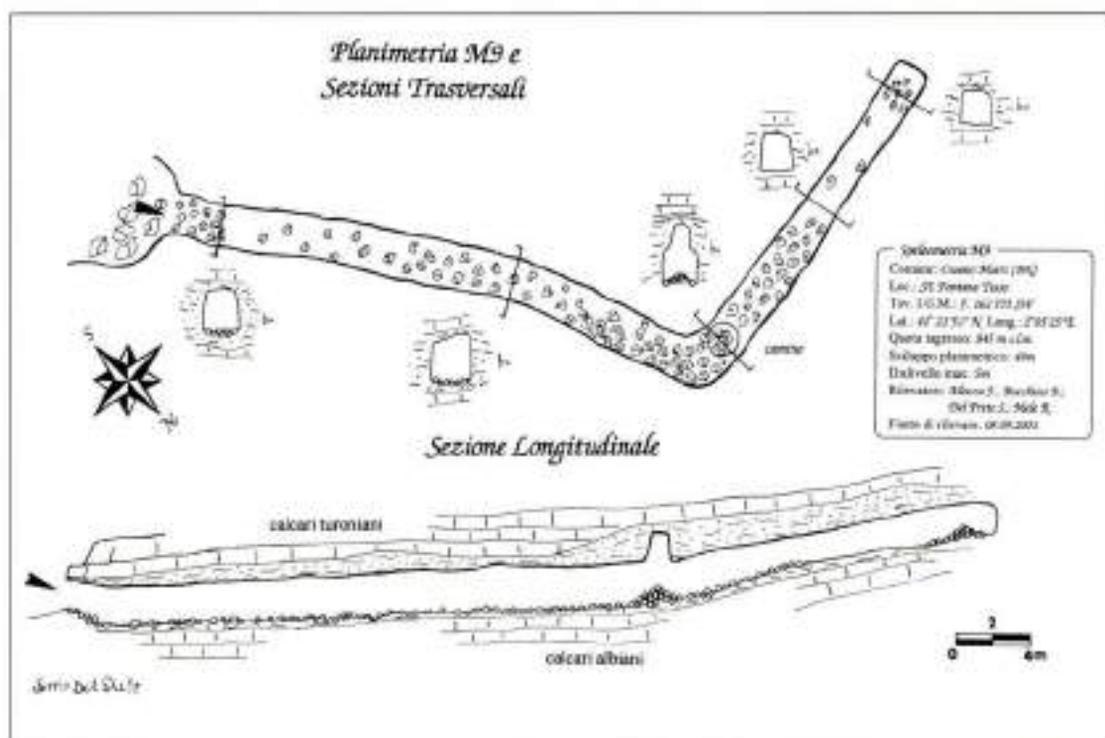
planimetria e sezione longitudinale della miniera M9 (grafica S. Del Prete).
